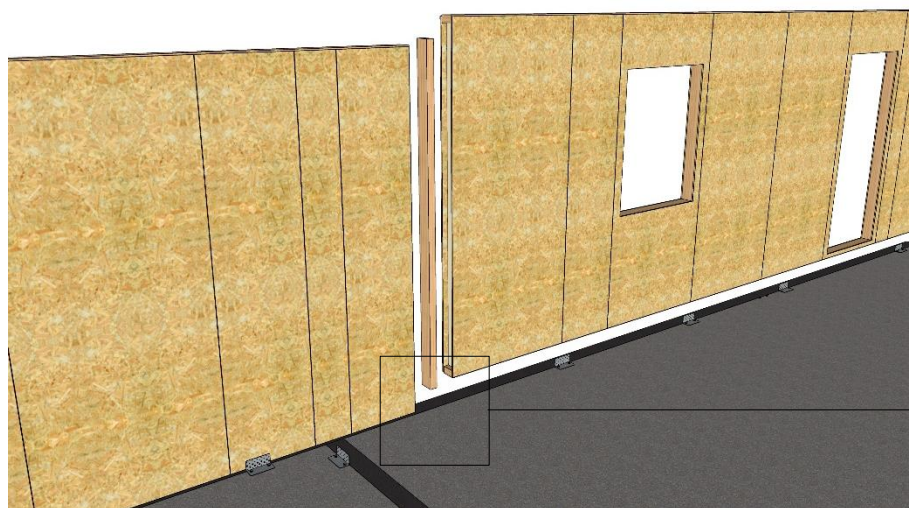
Insertion d'un montant de jonction entre panneaux de mur LogiWall® / Couturage au droit des plaques de parement intérieur et extérieur
